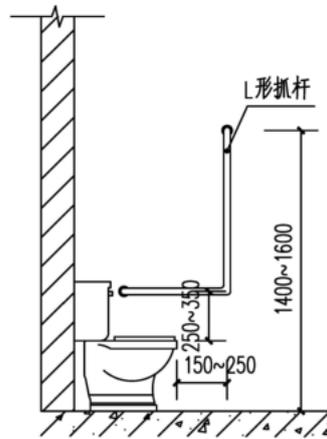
坐便器安全抓杆设置侧立面图
